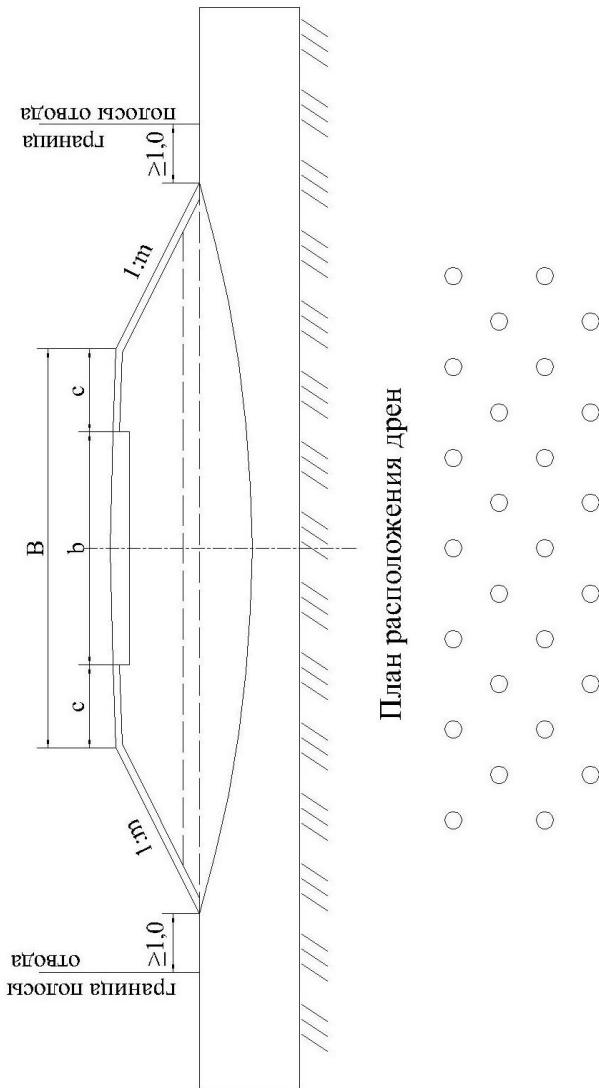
Насыпи на слабых основаниях с дренами из геотекстиля
